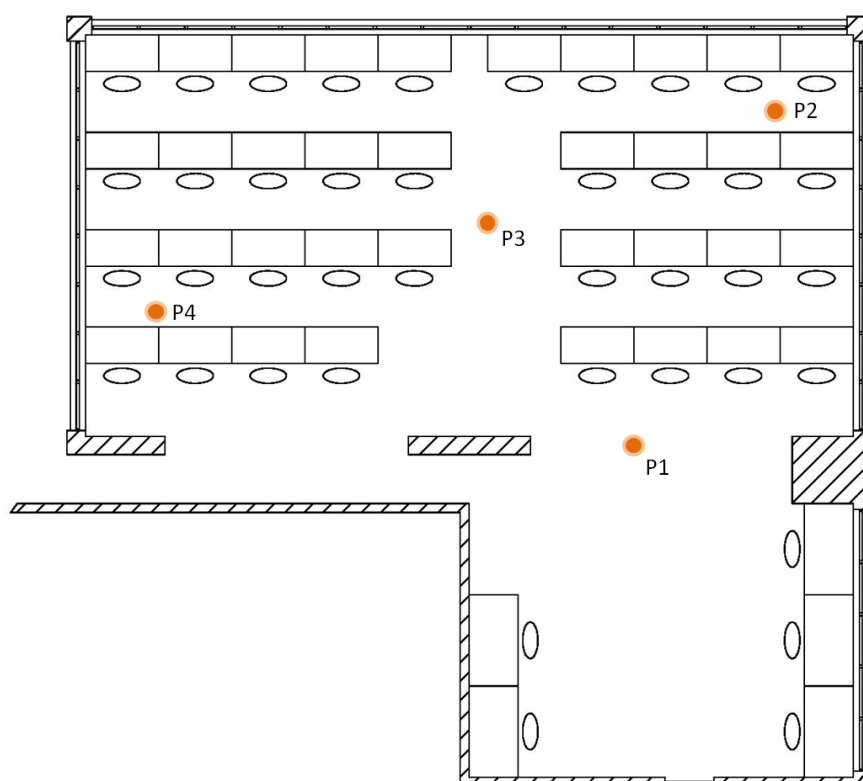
Esquema representativo da planta do open-space da Empresa B
